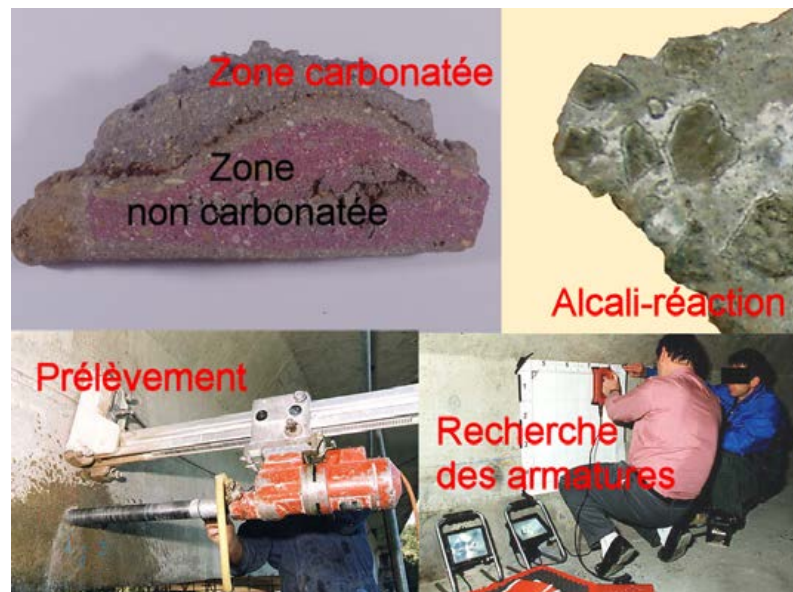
différents essais d'évaluation de l'état d'un support
